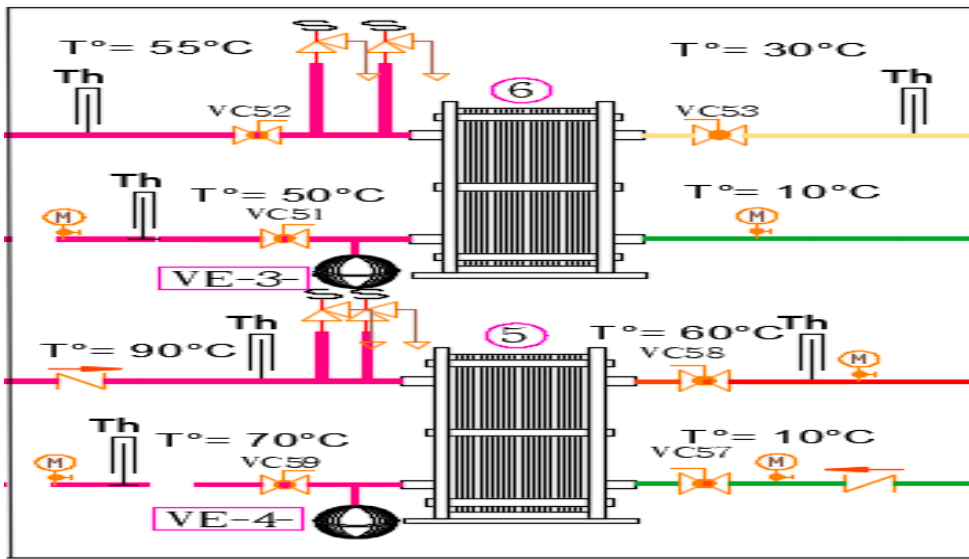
Schéma d'installation d'un échangeur a plaque et joint
